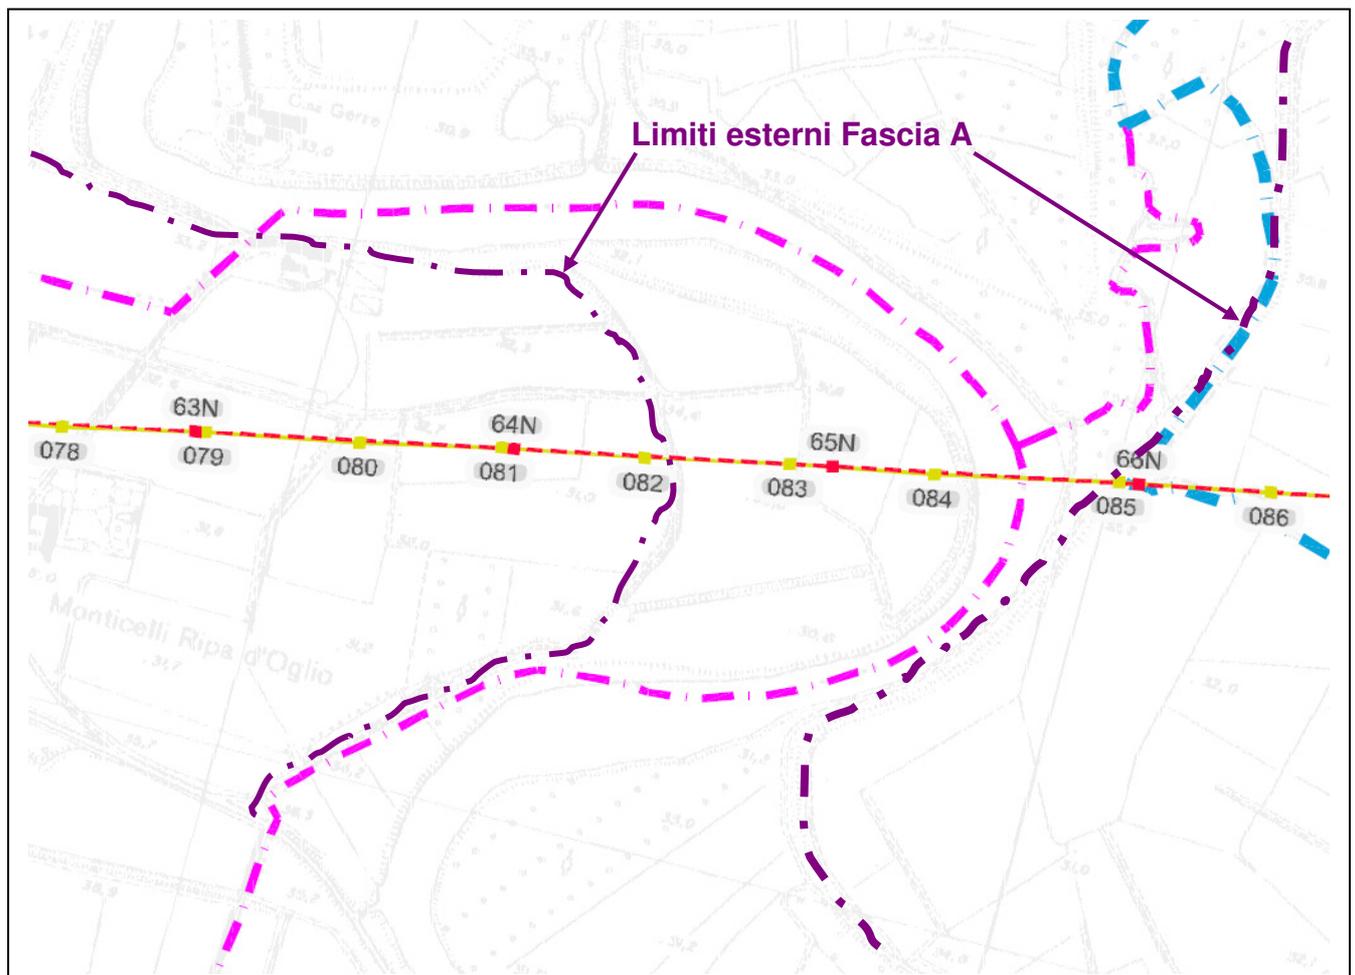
Planimetria del nuovo tracciato in attraversamento del fiume Oglio.
